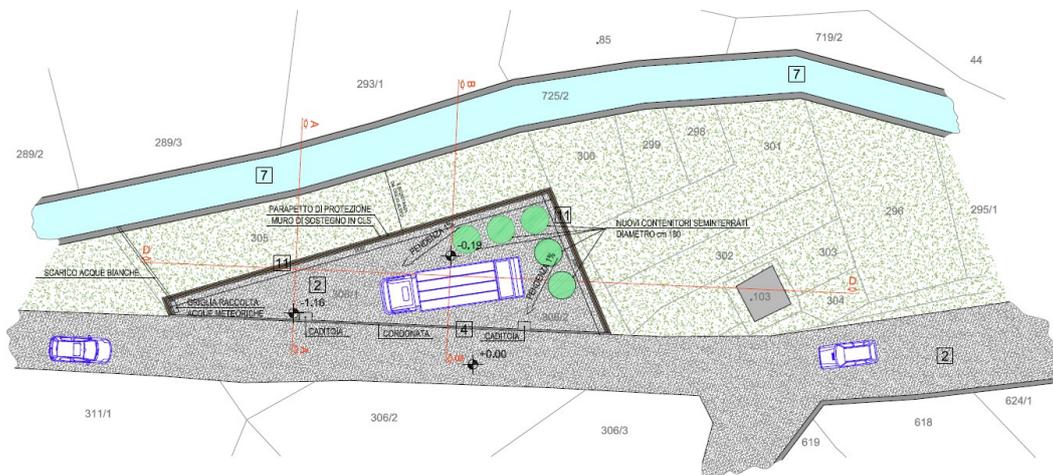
Estratto "Planimetria generale di progetto - intervento 5" scala a vista.
